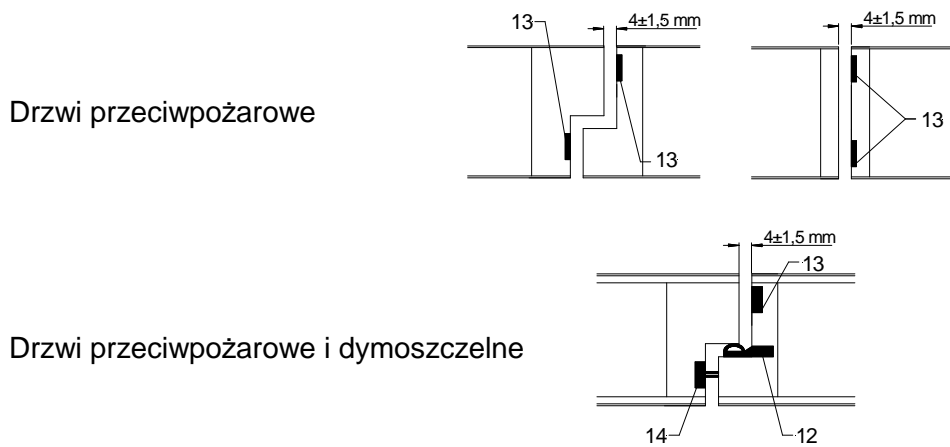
Drzwi typu HALSPAN EI 30 - przekroje pionowe A - A
